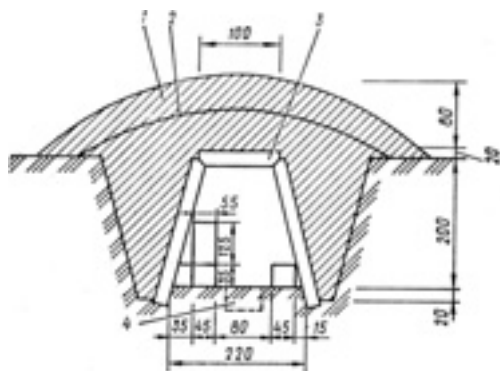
Быстровозводимое убежище типа «Фара»: 1 – насыпной грунт; 2 – гидроизоляция; 3 – элемент ПУ-1; 4 – прямок
